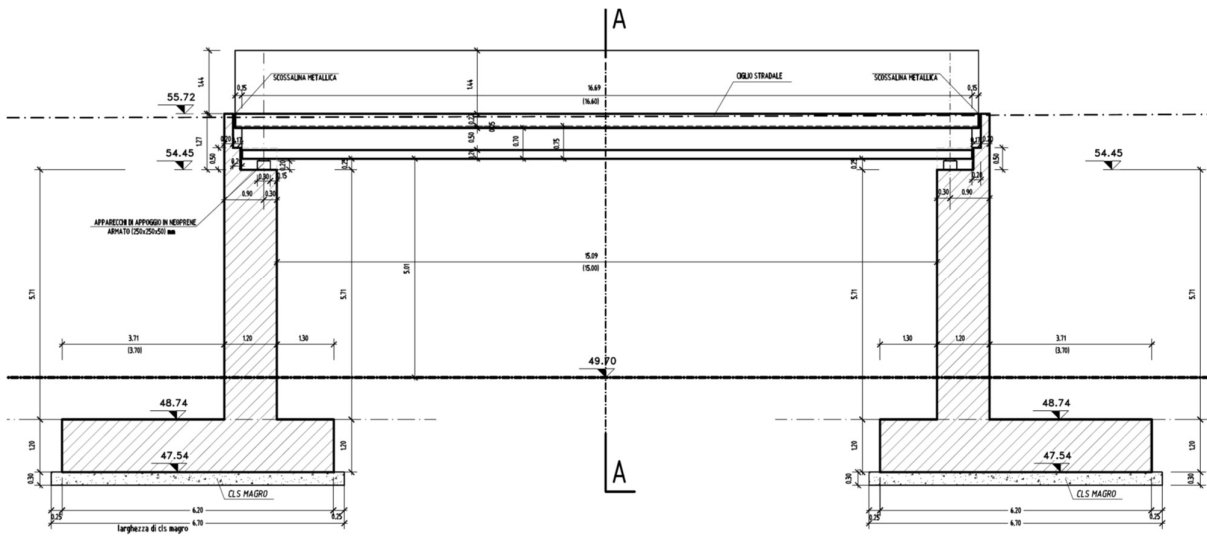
Sezione longitudinale struttura del 1° allargo
